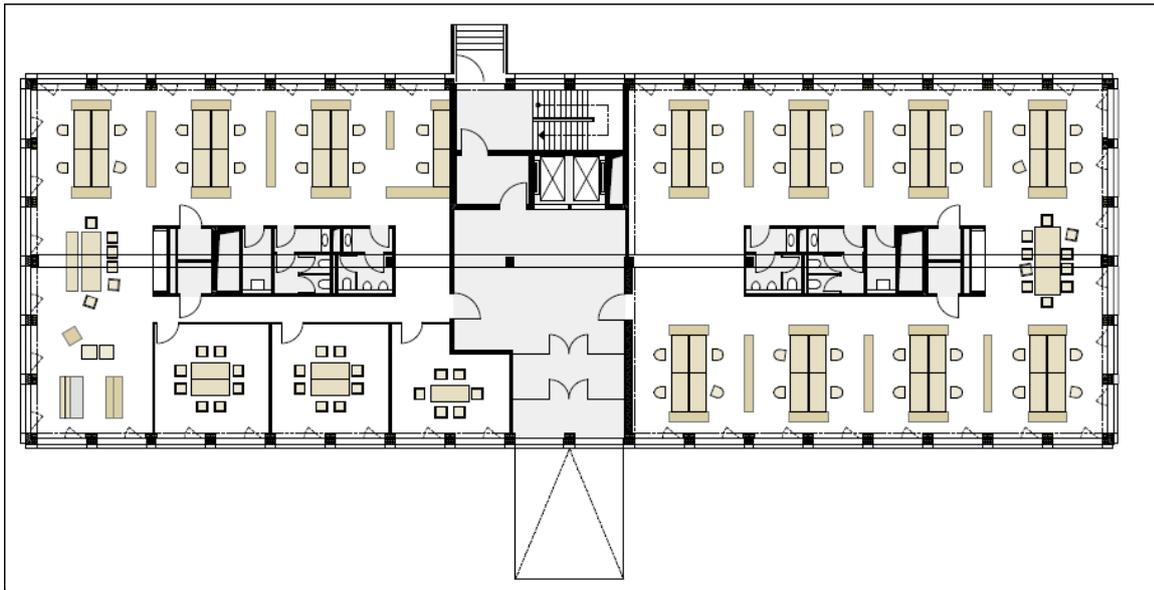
«Bürogebäude Handwerkerhaus» Bremen | Grundriss Erdgeschoss | © CREE Deutschland GmbH
